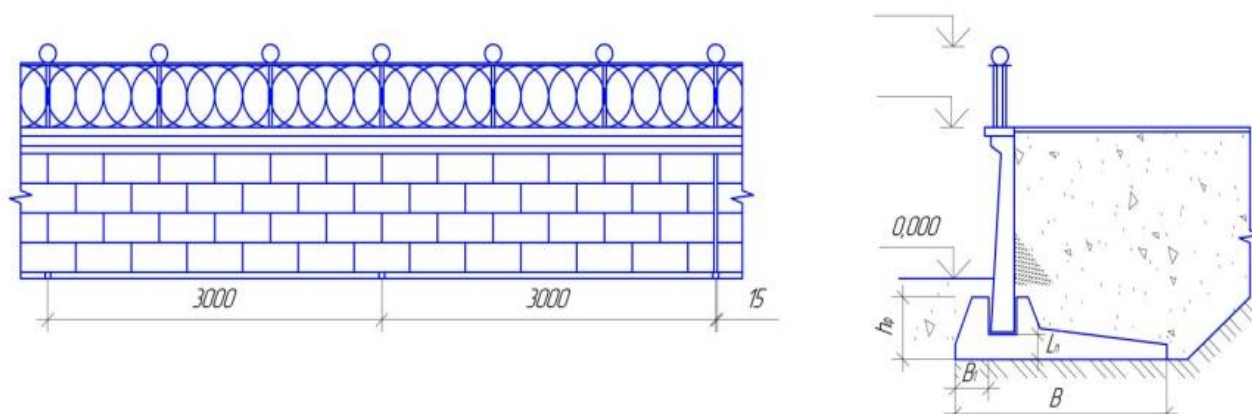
Фрагмент фасада подпорной стены и разрез
